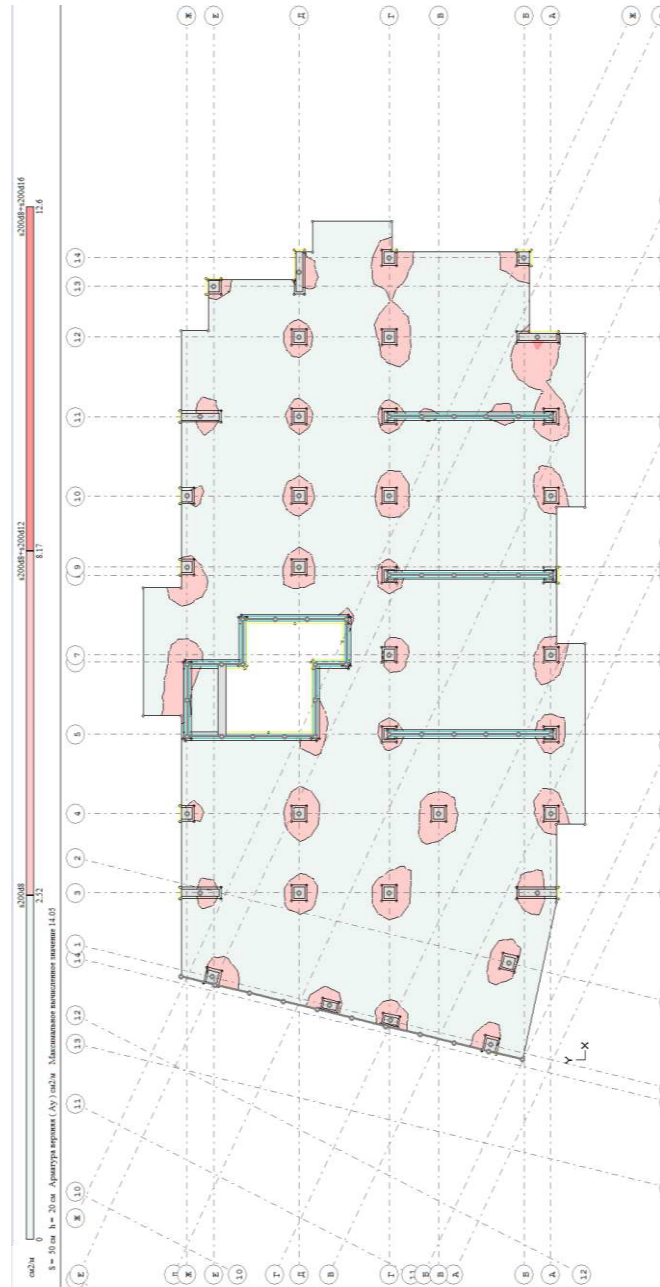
армирования плиты перекрытия типового этажа (толщина плиты 200мм, бетон В25)
